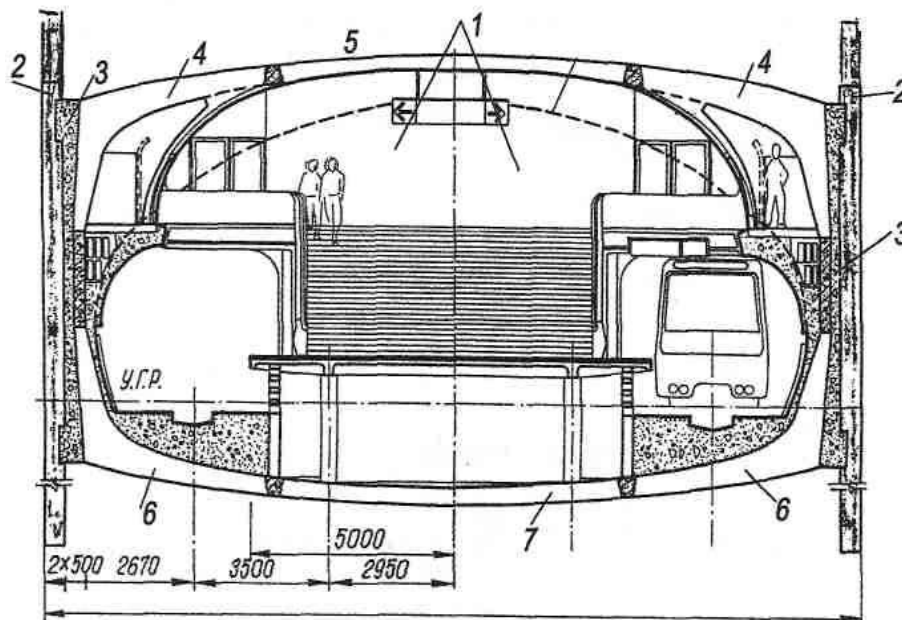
Односклепінчаста станція, зведена відкритим способом, із збірних залізобетонних елементів: 1 – внутрішній простір станції; 2 – що захищає «стіна в ґрунті»; 3 – опорна конструктивна вставка; 4 – верхні Г-подібні елементи; 5 – вигнута панель перекриття; 6 – нижні Г-подібні елементи; 7 – лоткова вигнута панель
